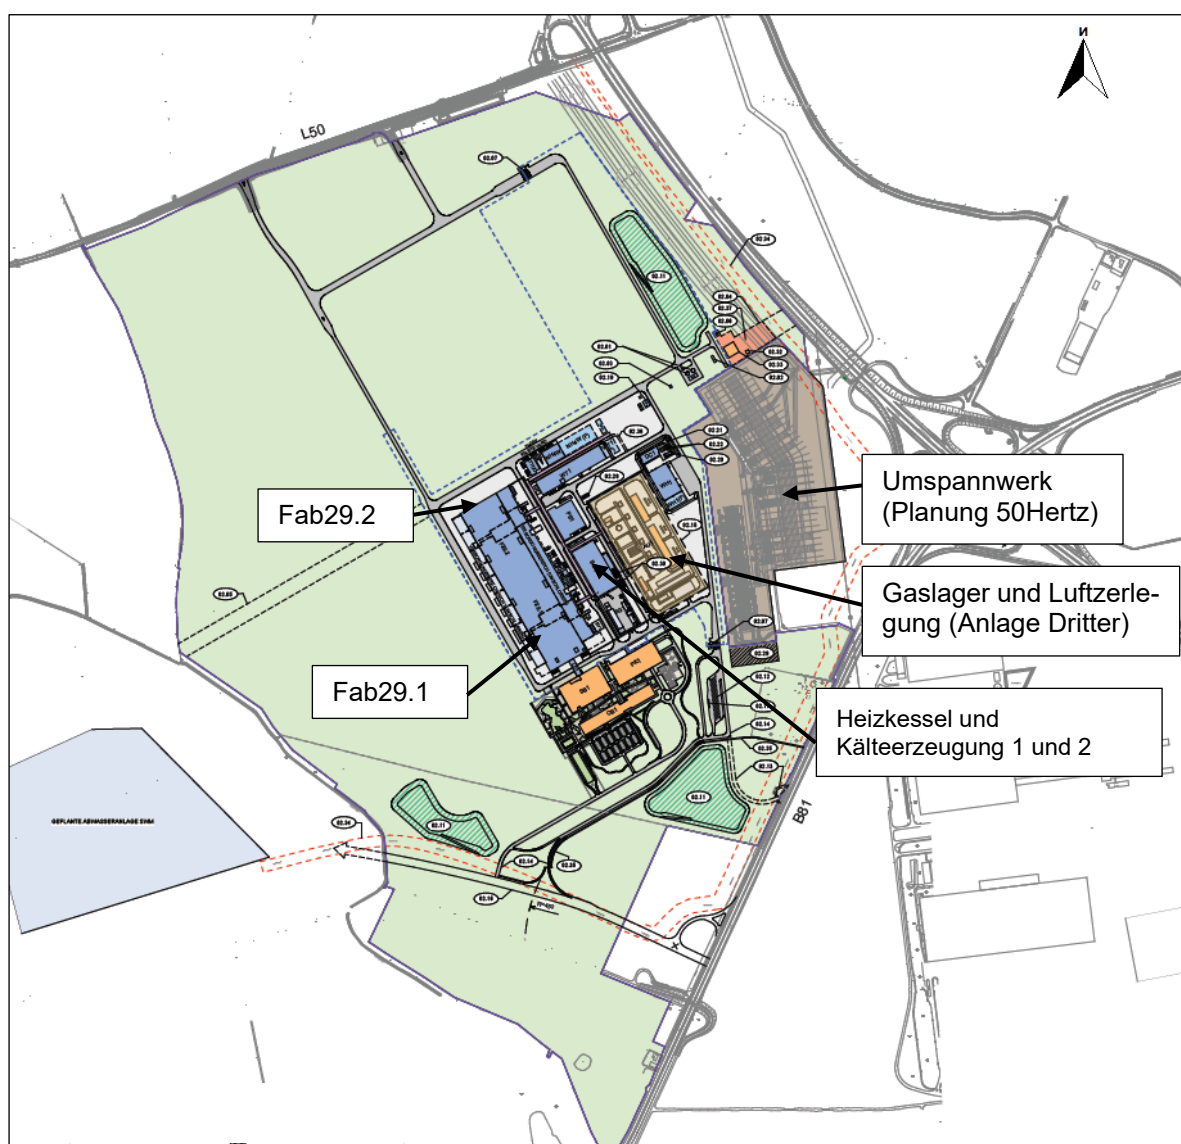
Lageplan mit Einordnung der Bebauung auf dem Betriebsgelände
